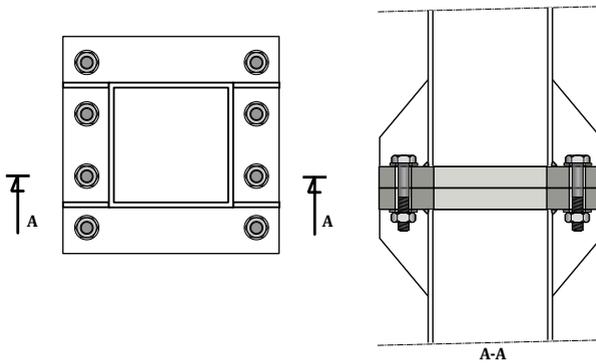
Assemblage de continuité par brides – Poteaux à section creuse carrée ou rectangulaire
